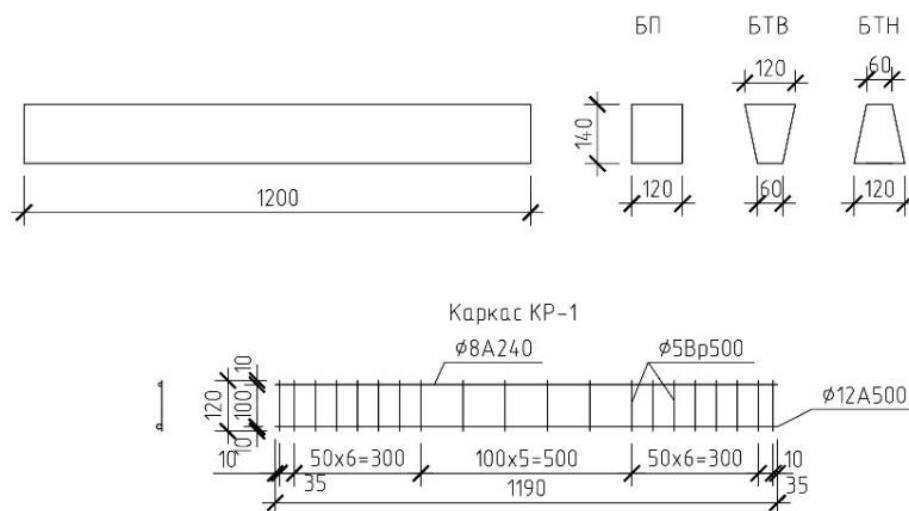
Геометрические размеры и схема армирования балок БП, БТВ и БТН
